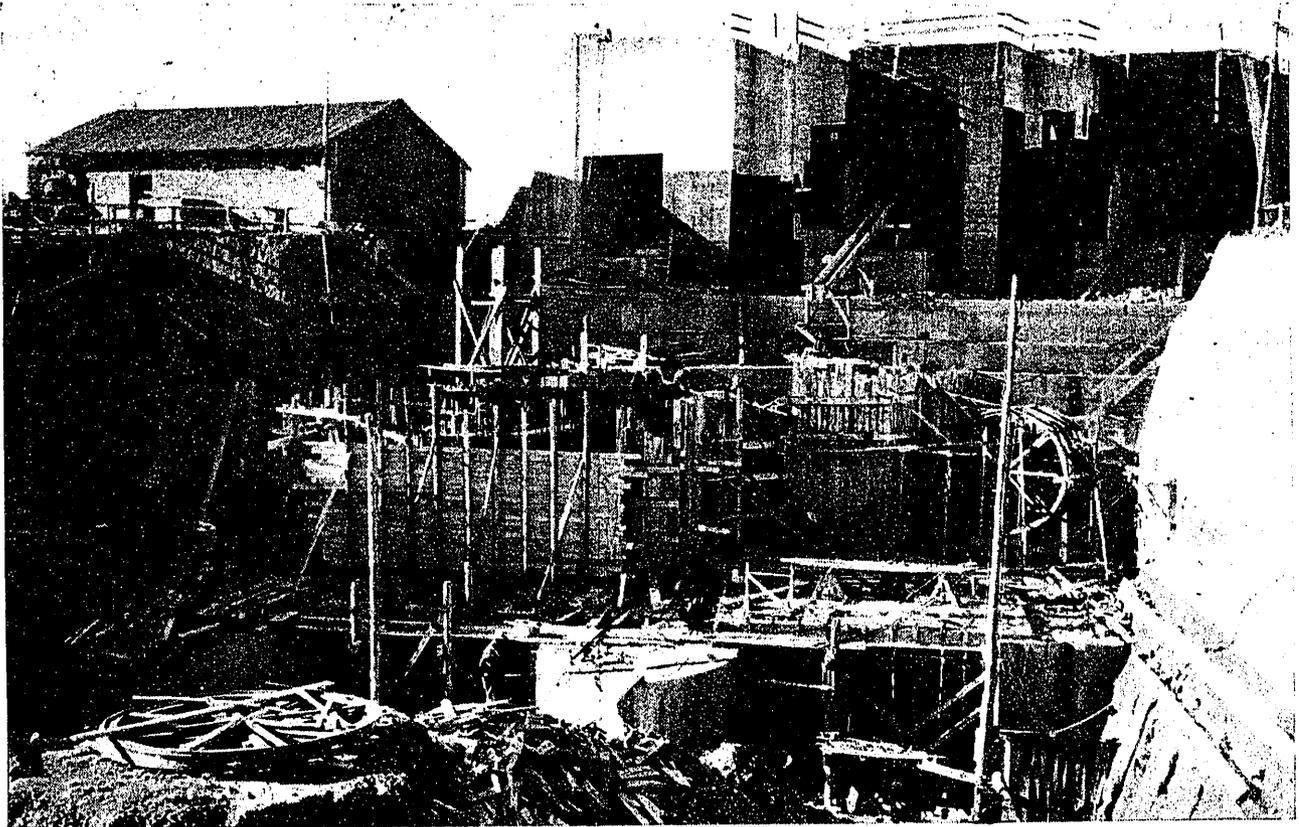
Construcción de la Central. Al fondo, las cabezas de las tuberías de presión con el alojamiento para las compuertas.
